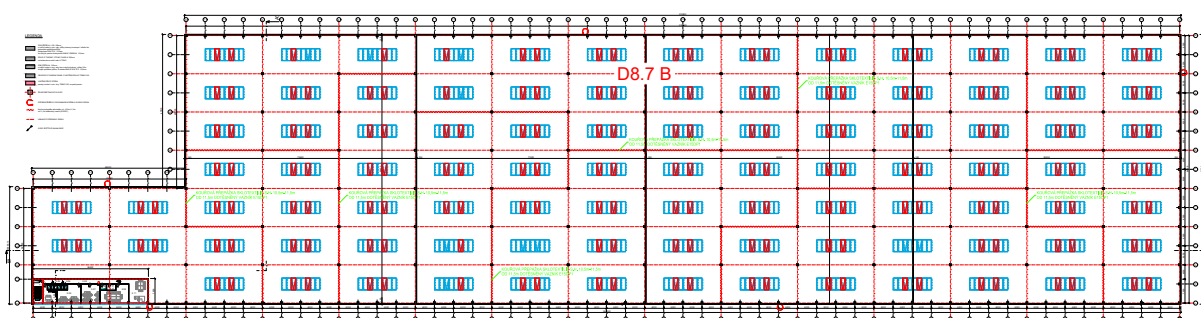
Hala D8-7B půdorys 2.NP vestavek [14]
